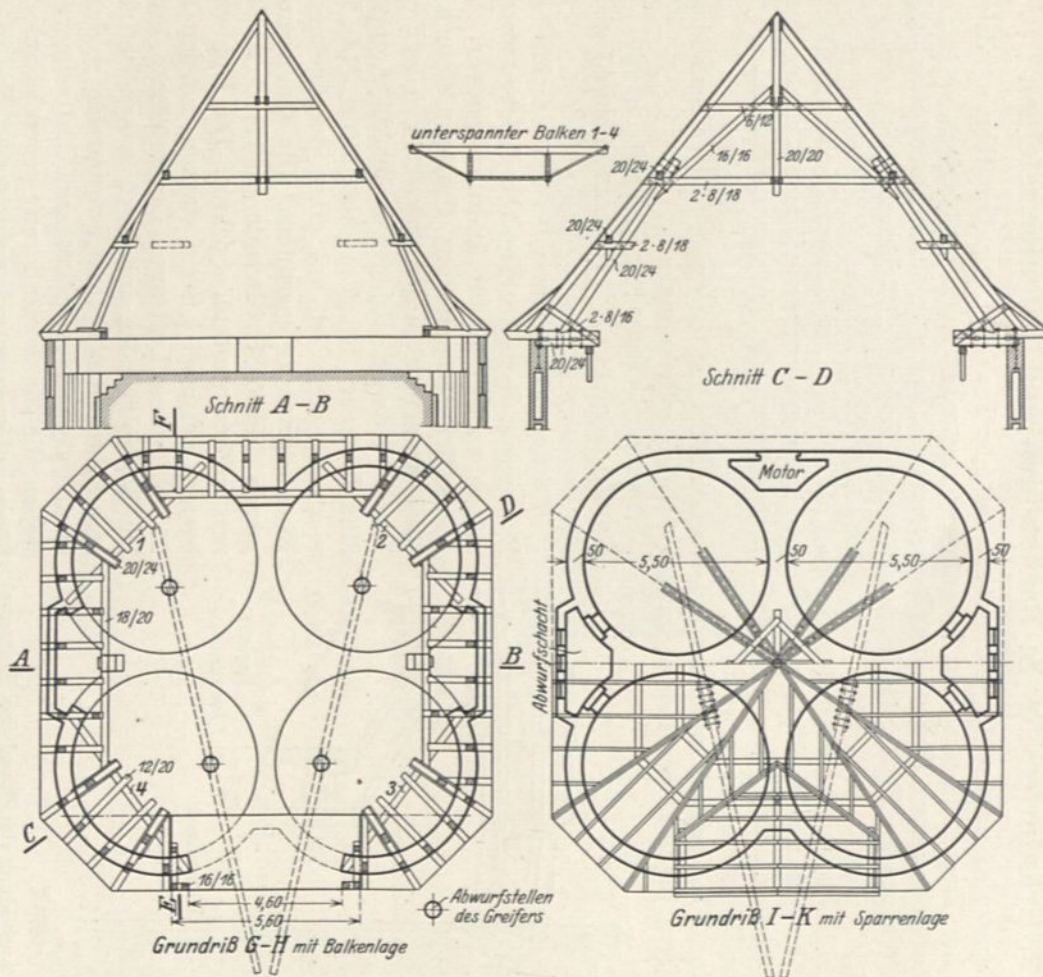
Grünfuttersilo Groß-Kussewitz. Grundrisse und Schnitte mit Ausbildung der Dachkonstruktion (vgl. Abb. 313).
